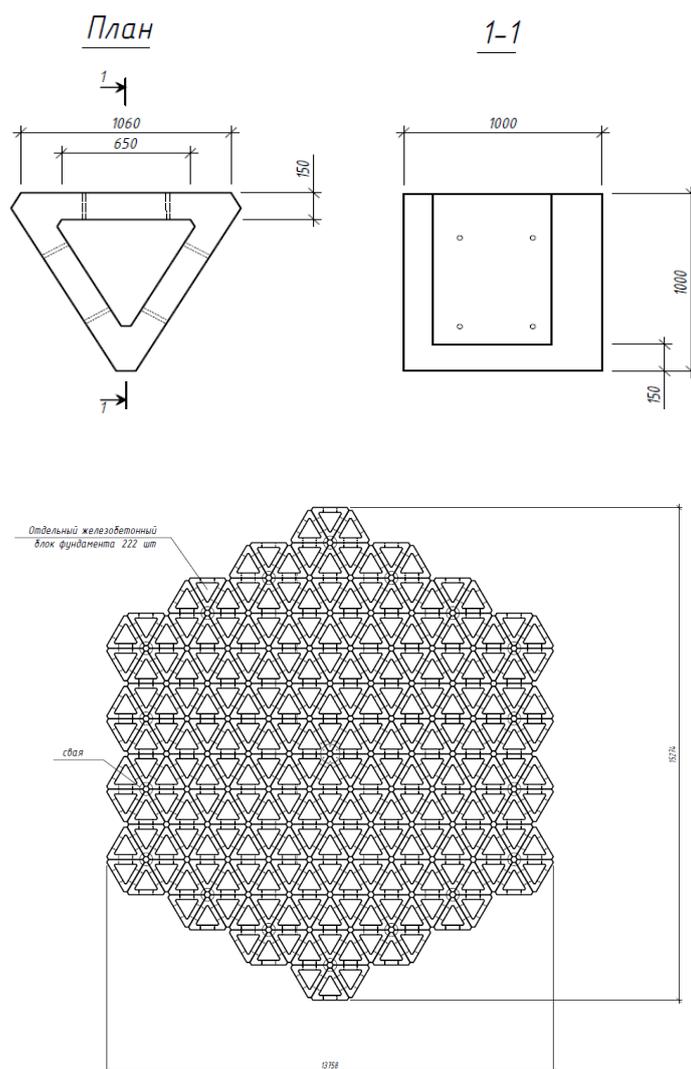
План, разрез и армирование модулей фундамента для башенного сооружения
